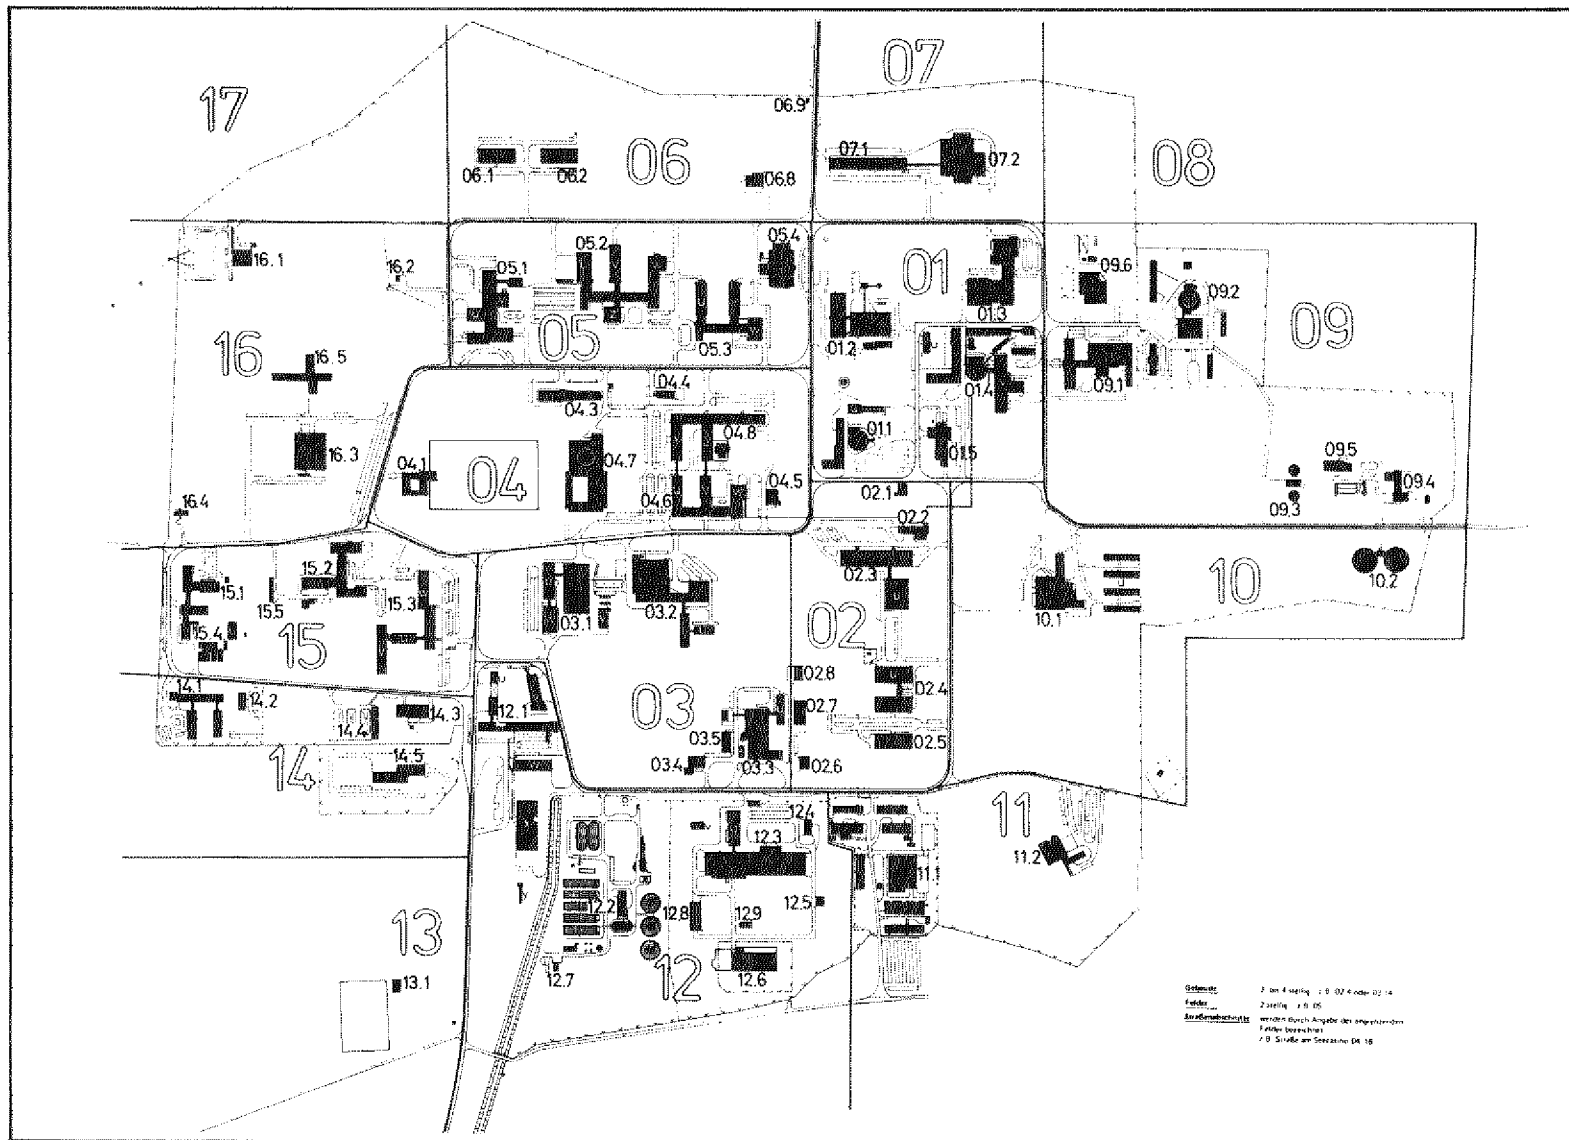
Lageplan mit Angabe der Gebäudenummern
